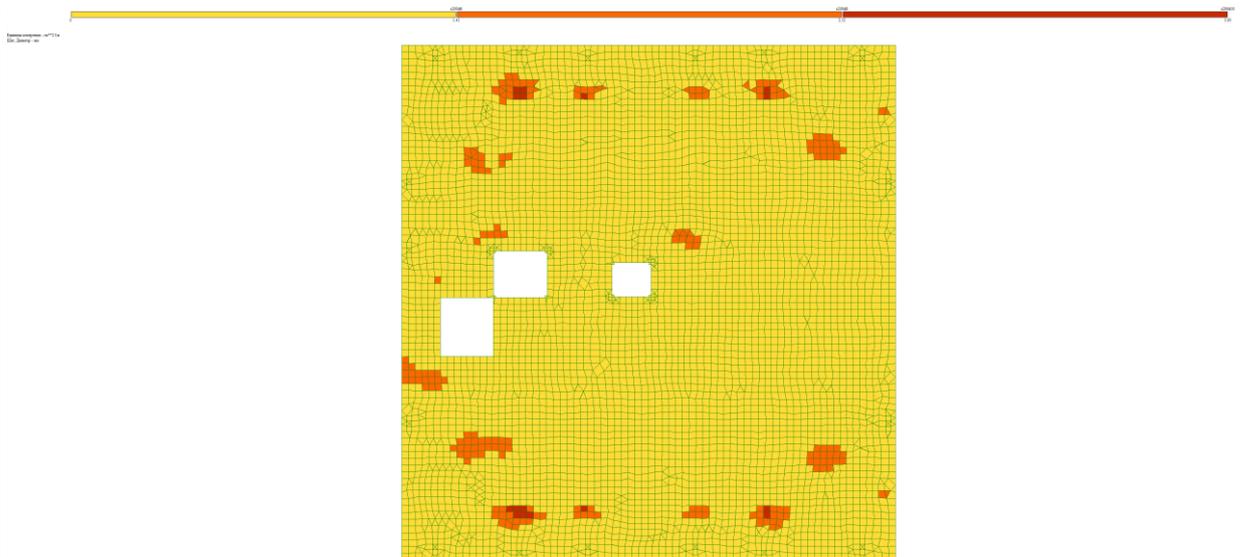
Нижнее армирование перекрытия этажа по оси Y
